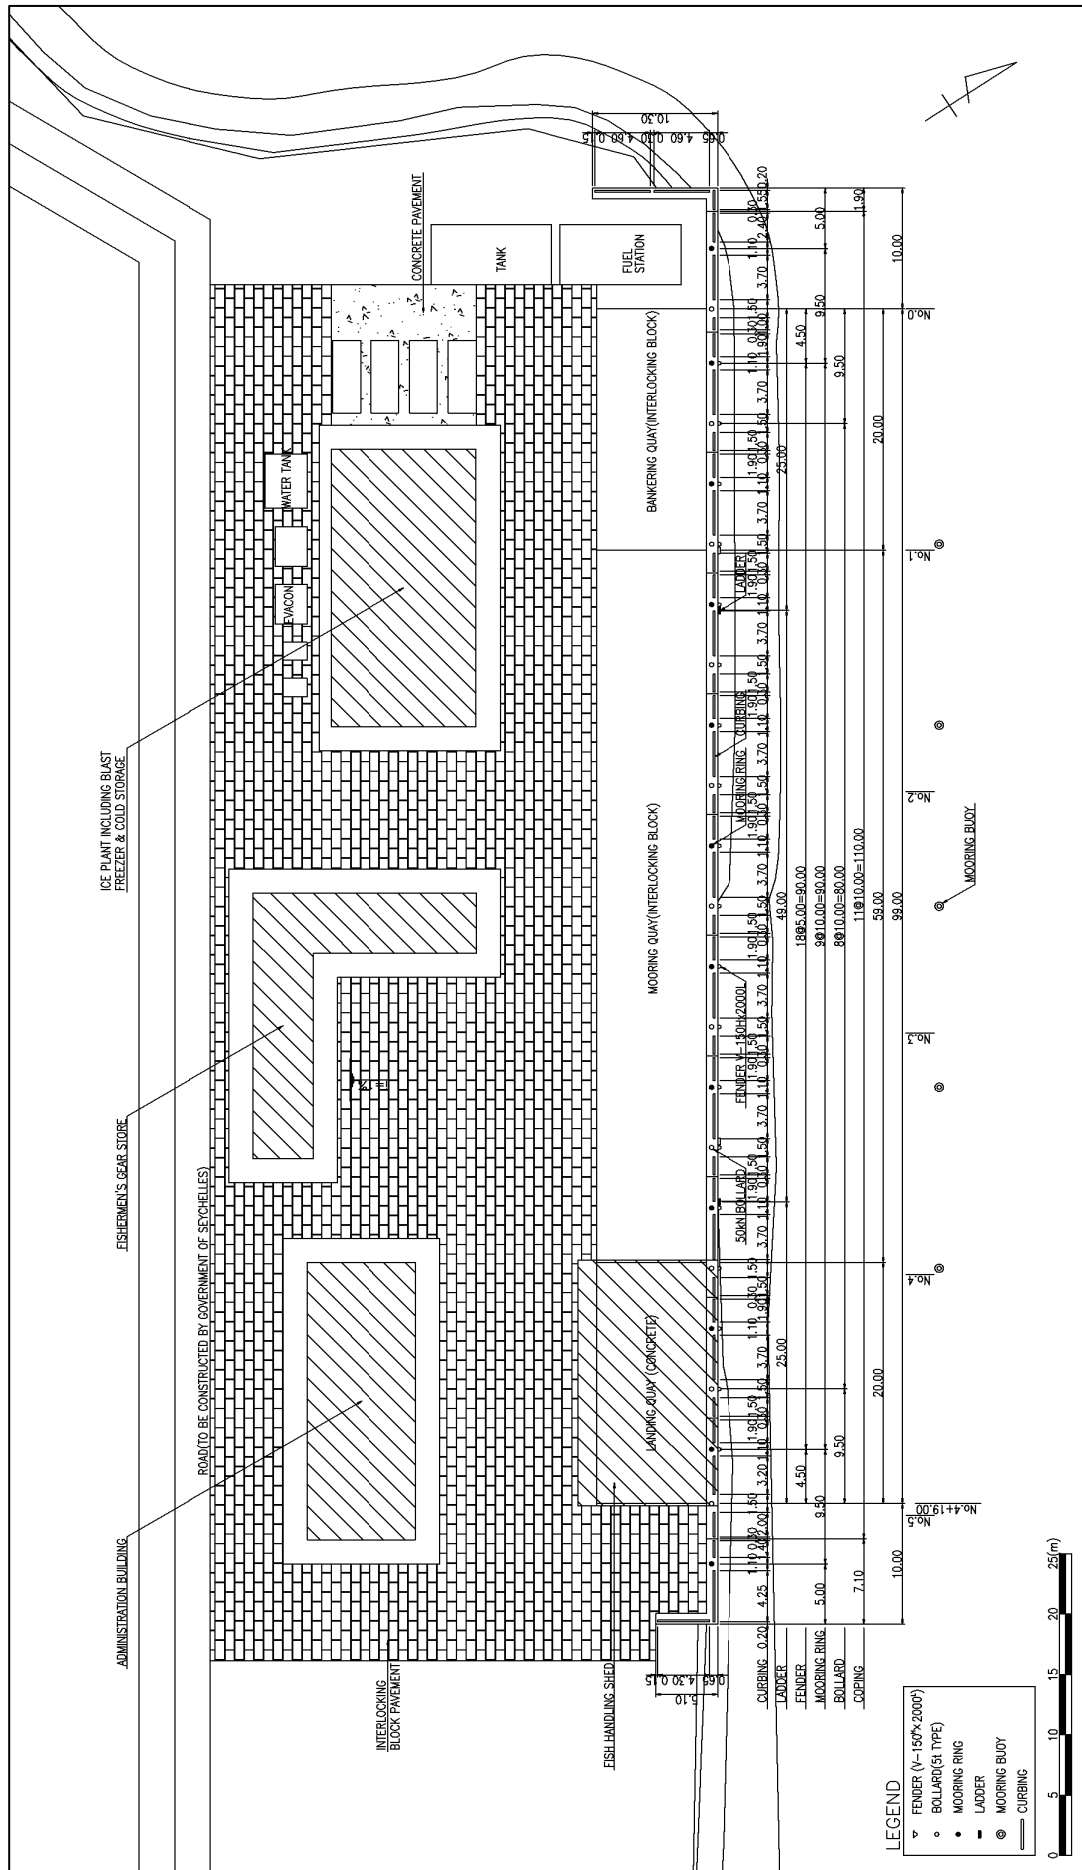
(2) 岸壁平面図 (プロビデンス漁港)
